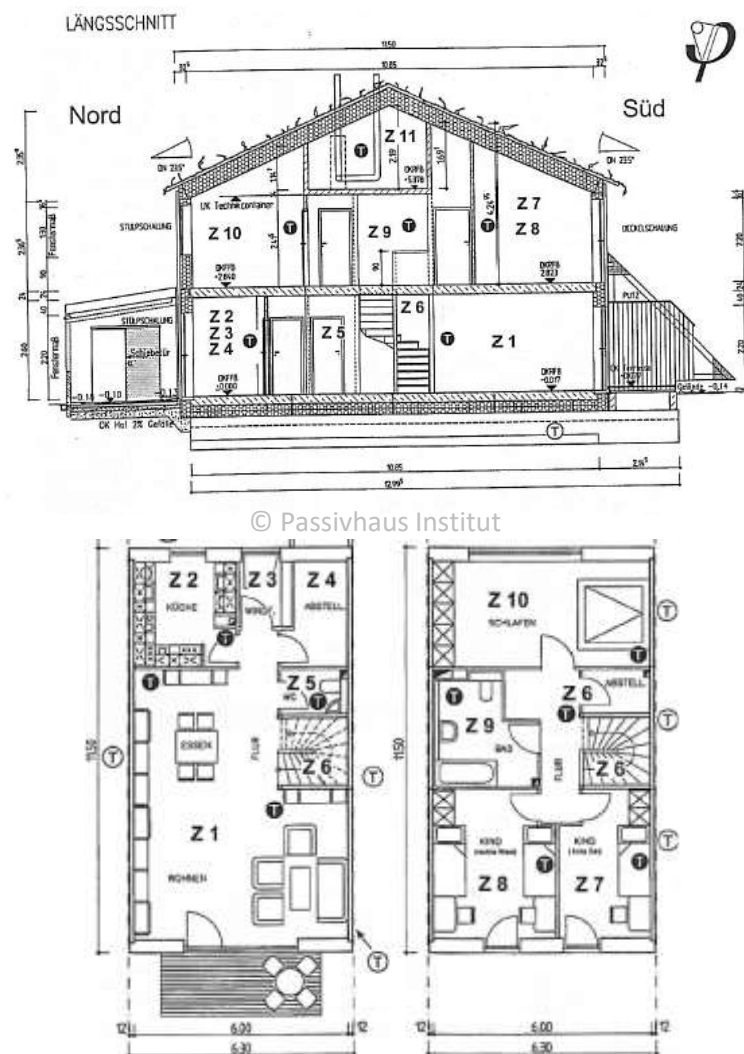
Ansicht und Grundrisssskizzen mit Zonenzuordnungen des Reihenhauses in Hannover Kronsberg.
